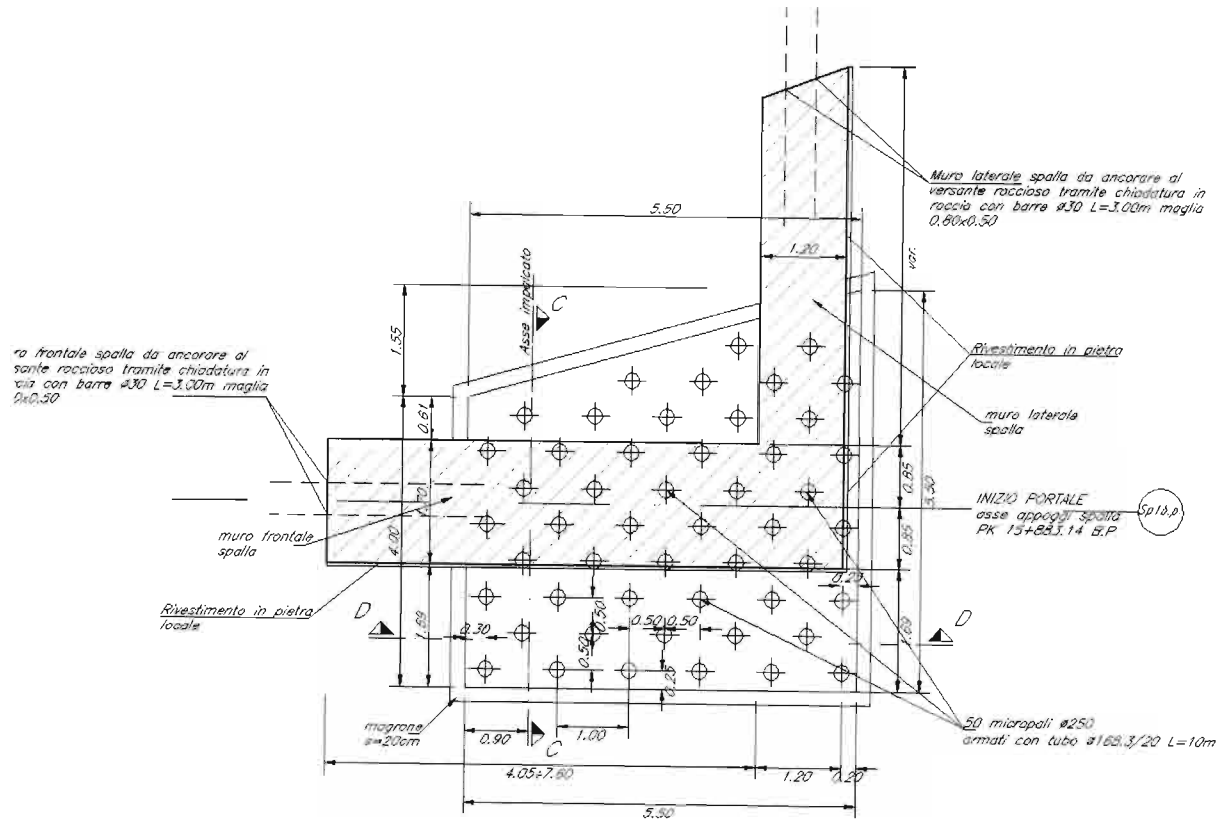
Sezione longitudinale e trasversale della spalla lato Scaleres VI01 (B.P.)
